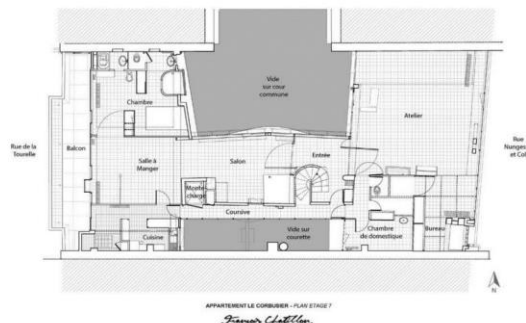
Plan de l'appartement. (Source : www.lescouleurs.ch, 2023)
